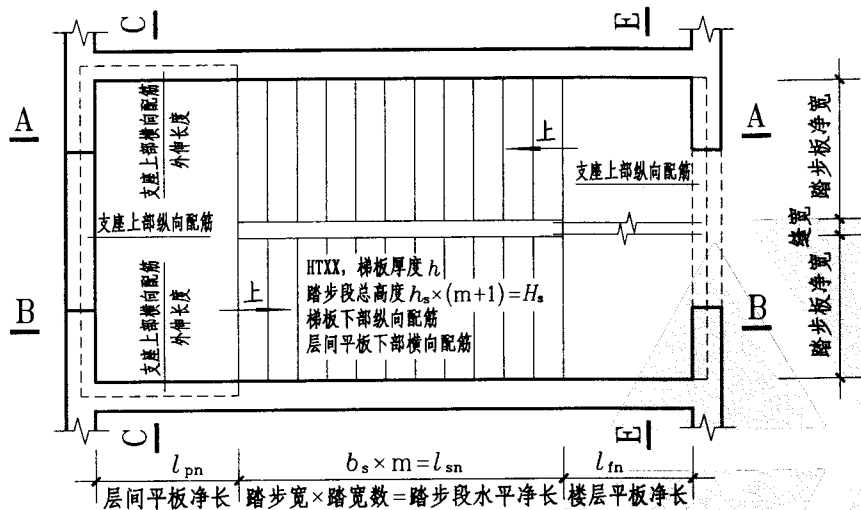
注写方式 标高XXX—标高XXX楼梯平面图
